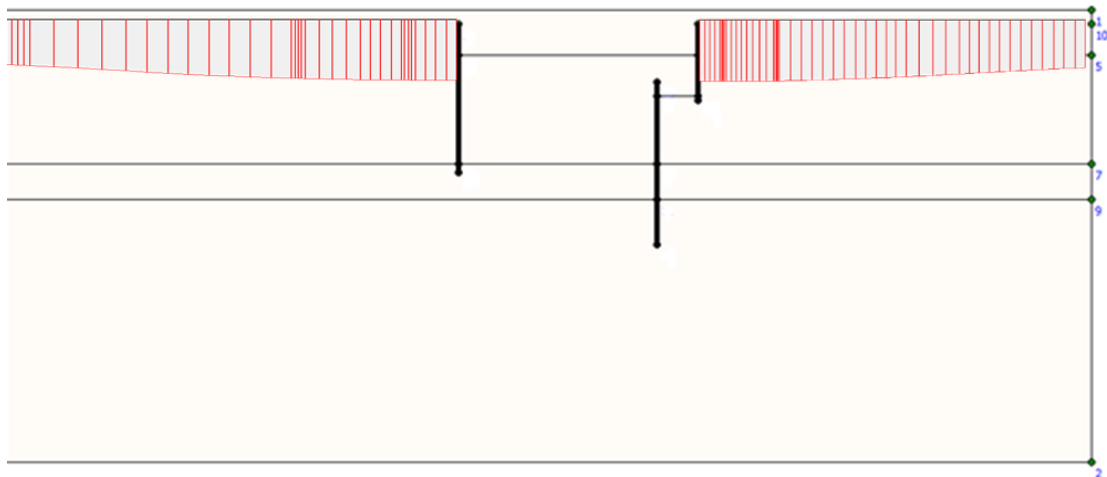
Section Type B – COMB_FOND – Tassements autour de l'excavation
